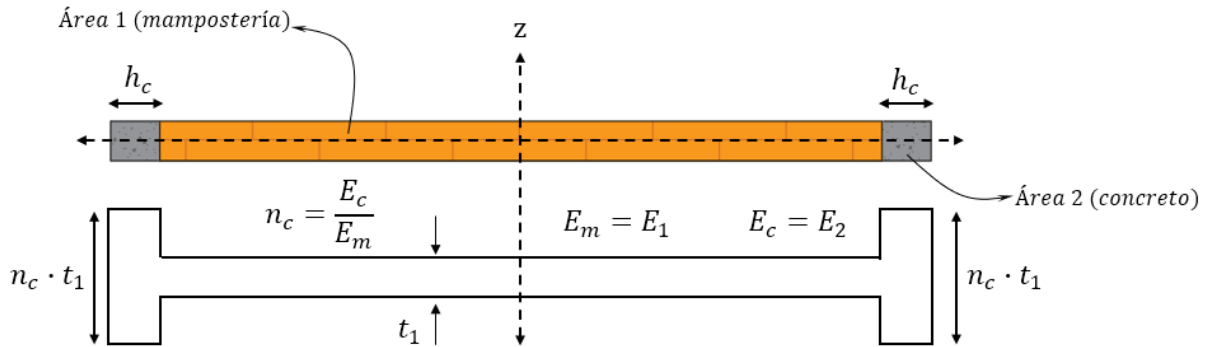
Sección transversal del muro de mampostería confinada y su sección transformada
